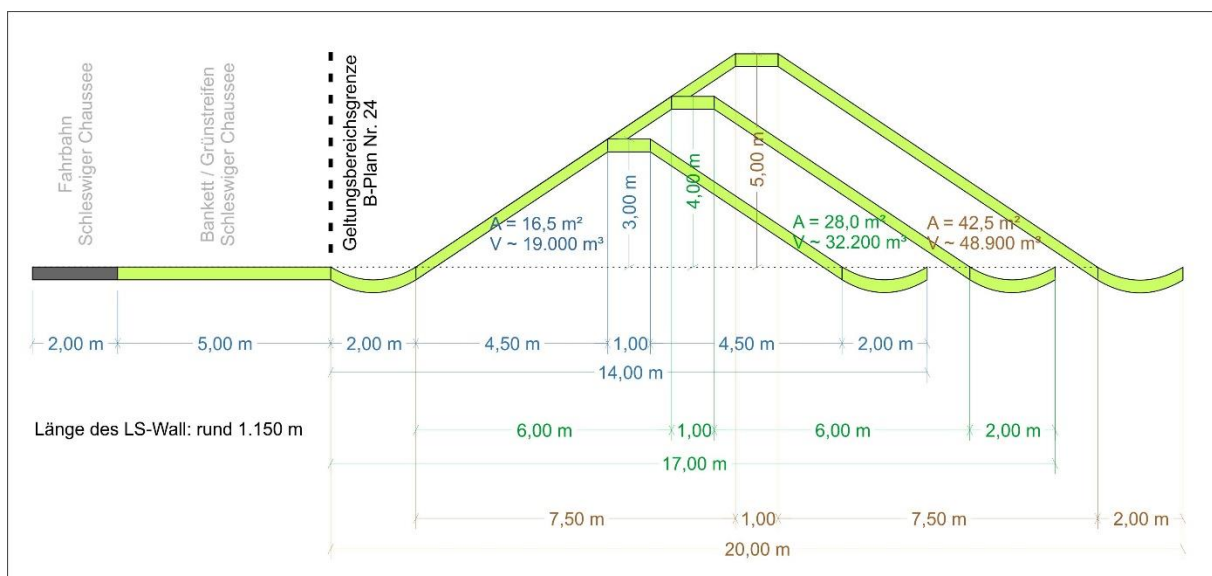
Prinzipische Querschnittszeichnung des Lärmschutzwalles
